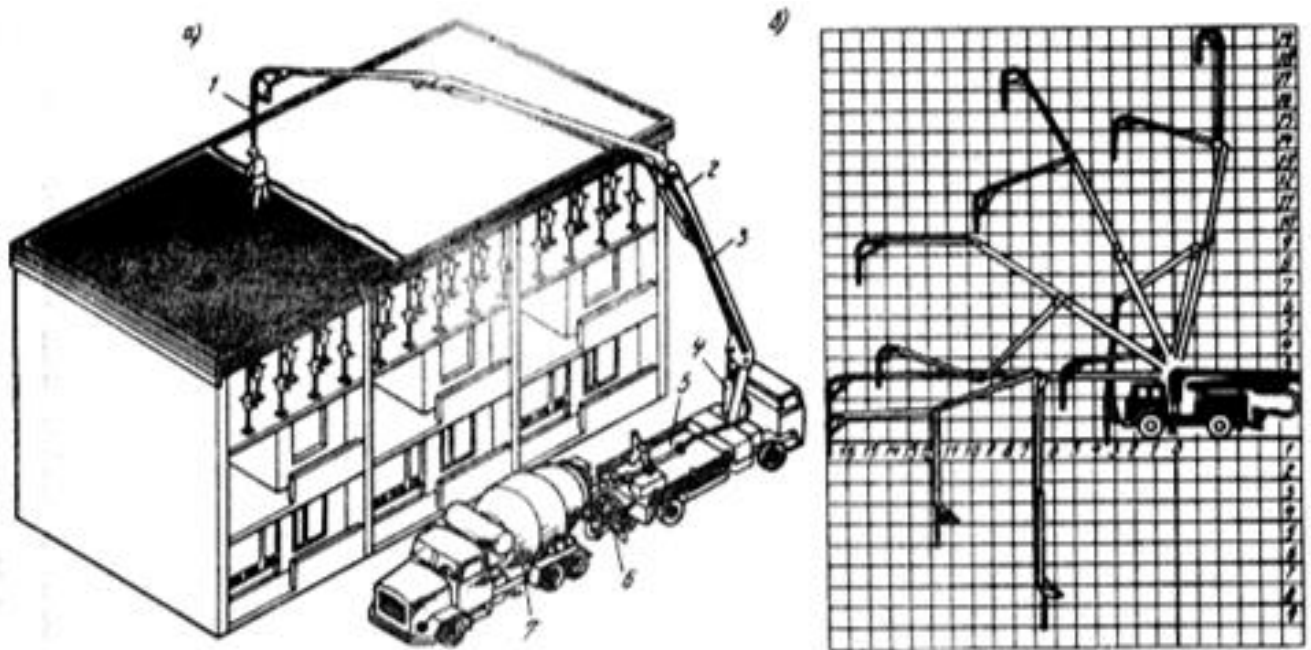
Схема машин при подачі бетонної суміші бетононасосом
